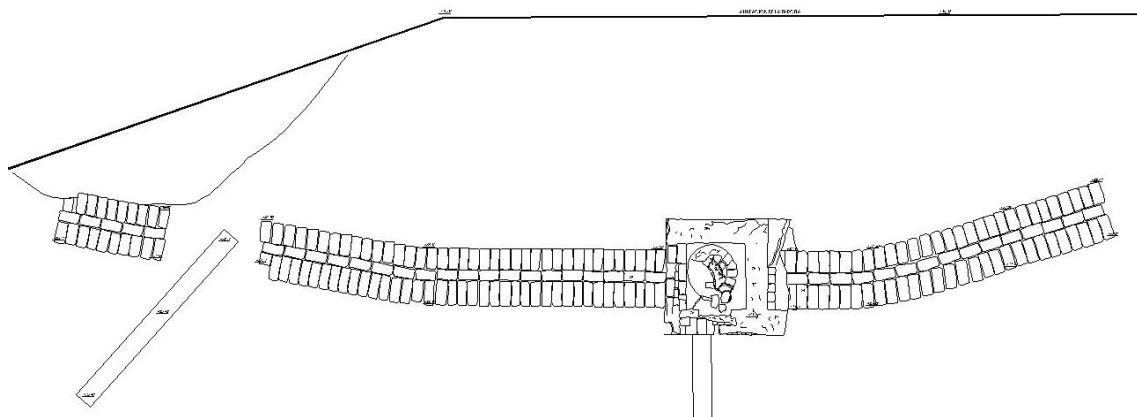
Planta del conjunto hidráulico con la nueva acometida.
